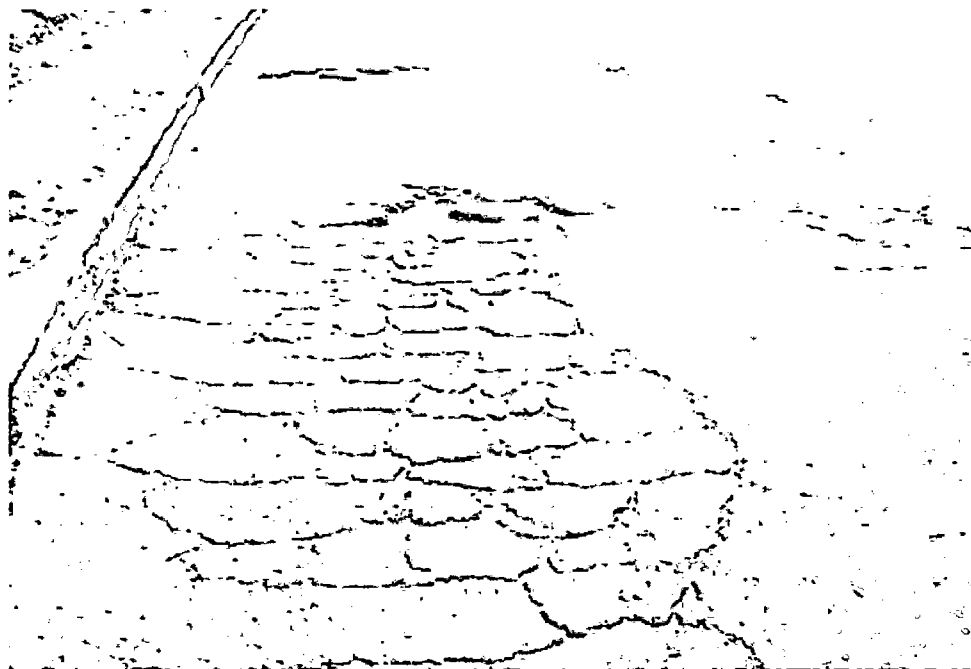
Nivel alto de fisuramiento en bloque.
